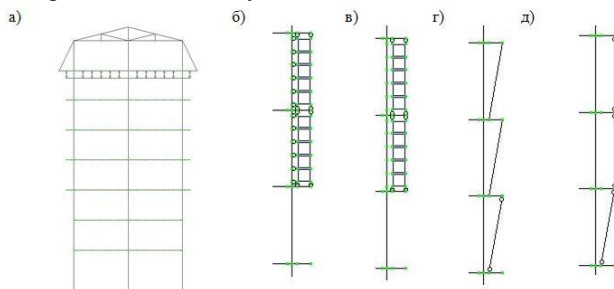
Расчетная схема здания (а) и фрагменты расчетной схемы с консольными ригелями перекрытий 2-5 этажей и усилением при помощи монолитных железобетонных диафрагм с обоями по колоннам (б), то же без обоев (в), постановкой подкосов (г), постановкой подкосов и распорок (в)
